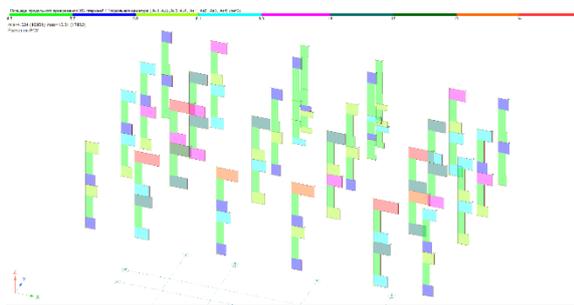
Расположение колонн и максимальная площадь армирование в колоннах на четвёртом и пятом этажах пяти этажного каркасного железобетонного здания без внутренних и наружных стен.
